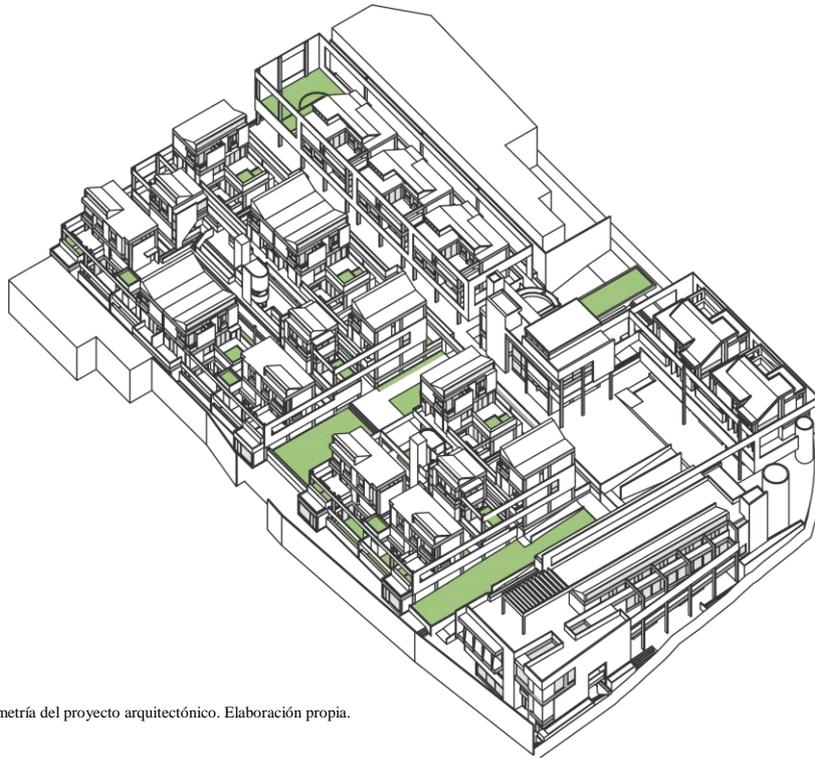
Axonometría del proyecto arquitectónico. Elaboración propia.
